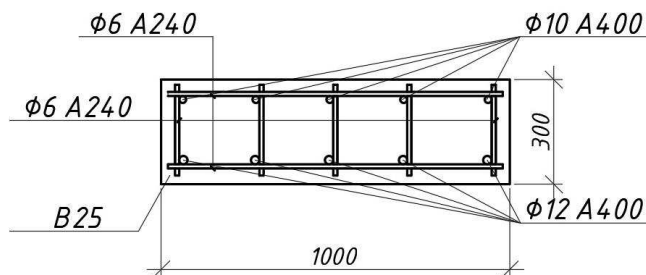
Схема армирования монолитной фундаментной ленты
